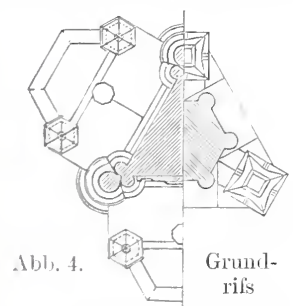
Grundriss in Höhe des Kaiserbildnisses.
